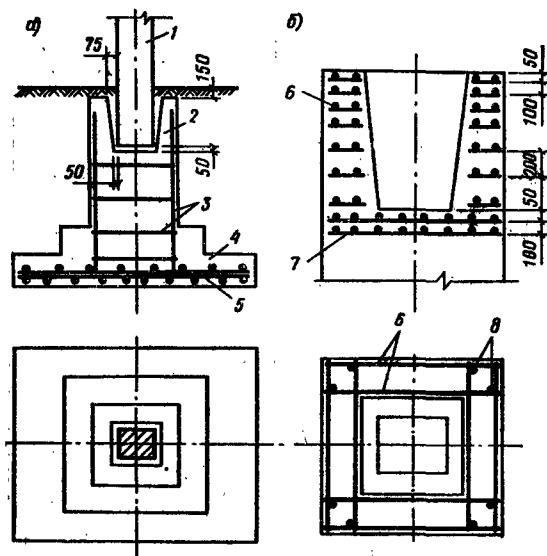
Конструкция монолитного отдельного фундамента, сопрягаемого со сборной колонной
